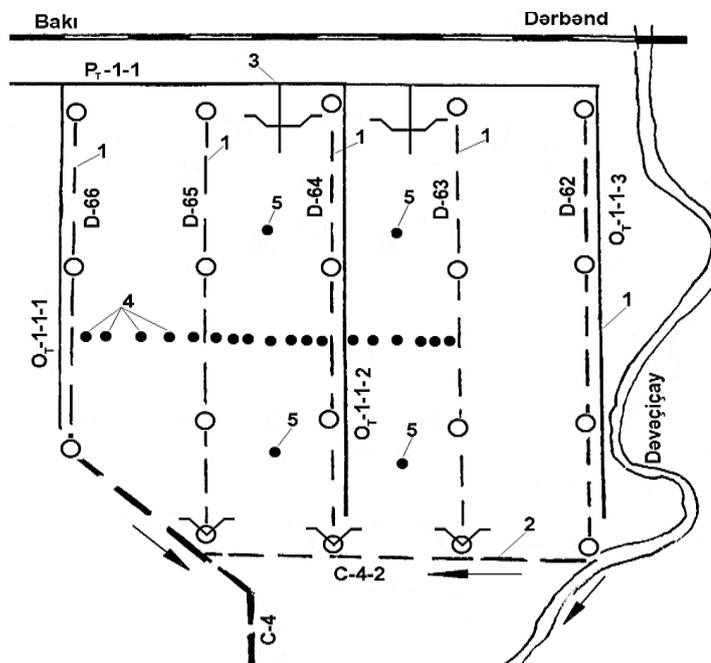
Опытно-дренажный участок с закрытыми дренажами с керамическими трубами с отверстиями покрытой водоливом с. Гюлемли Шабранского района
